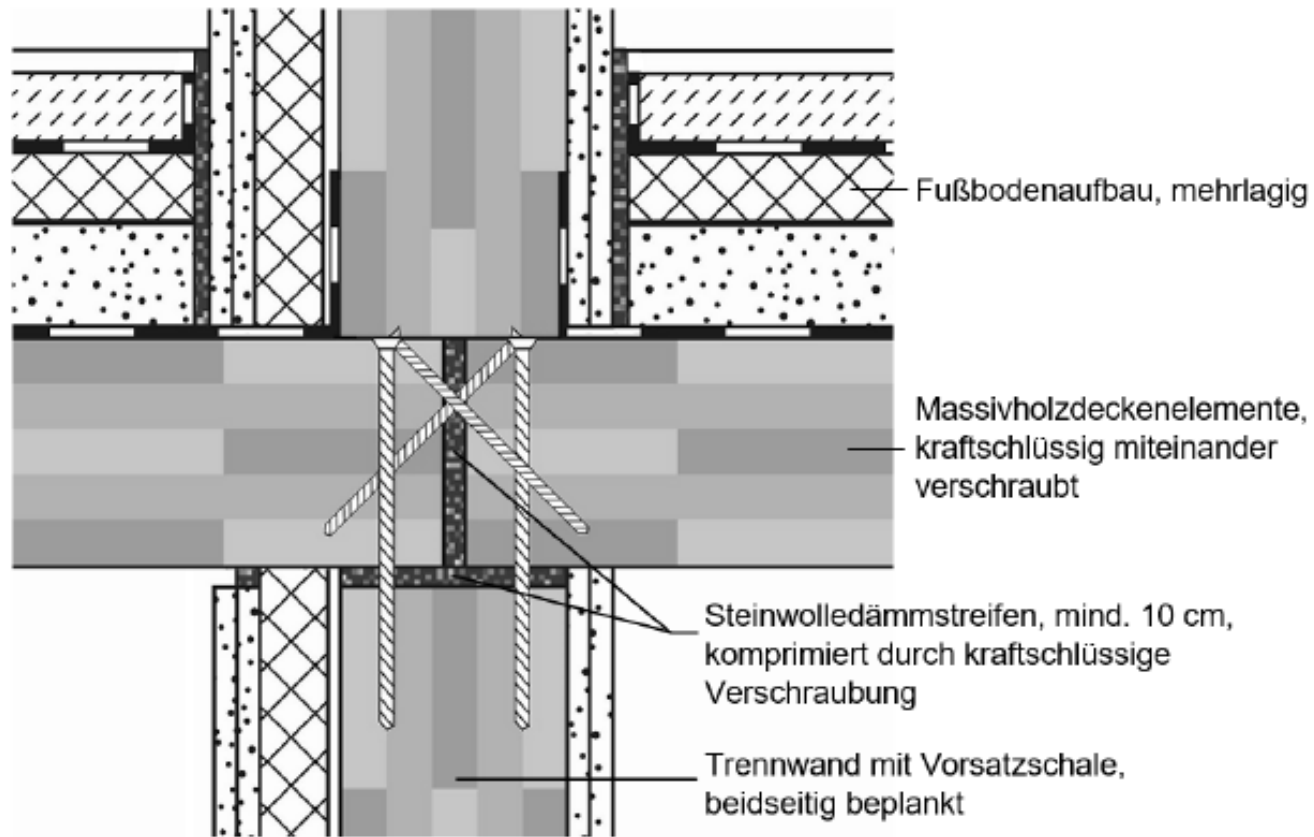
Bauteilanschluss Trennwand an Geschosdecke (Vertikalschnitt)
